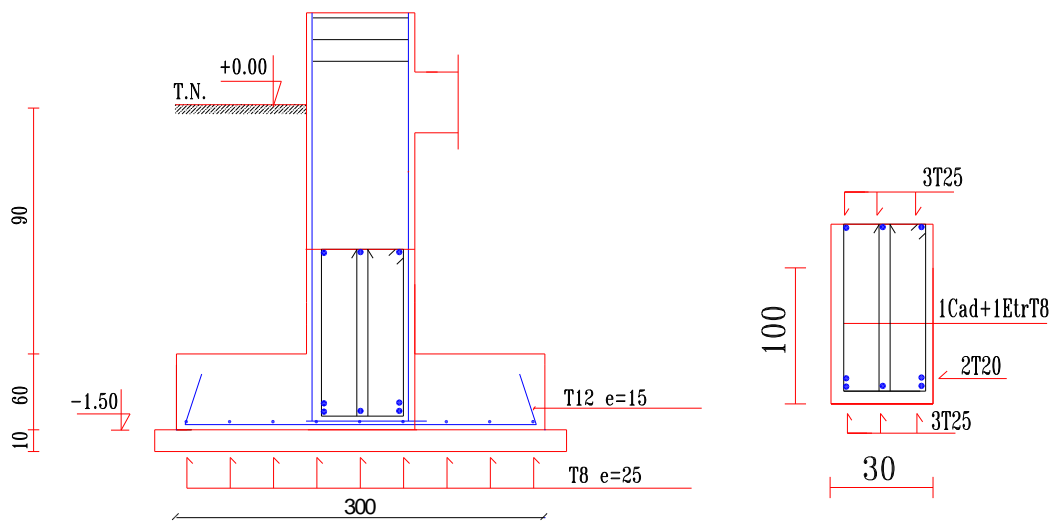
Schéma de ferrailage des semelles filantes appui X-X
